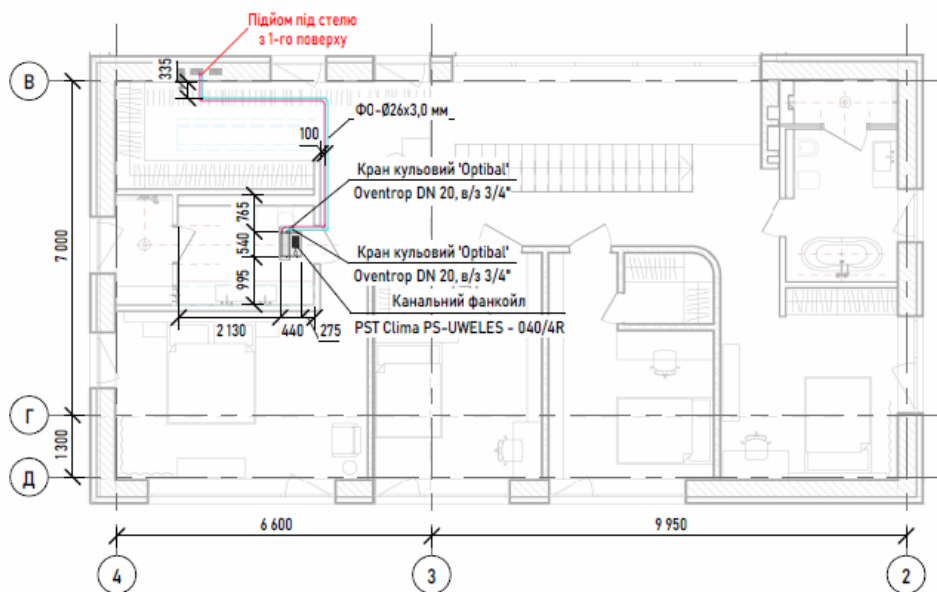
Система холодопостачання фанкойлів. План 2-го поверху.
